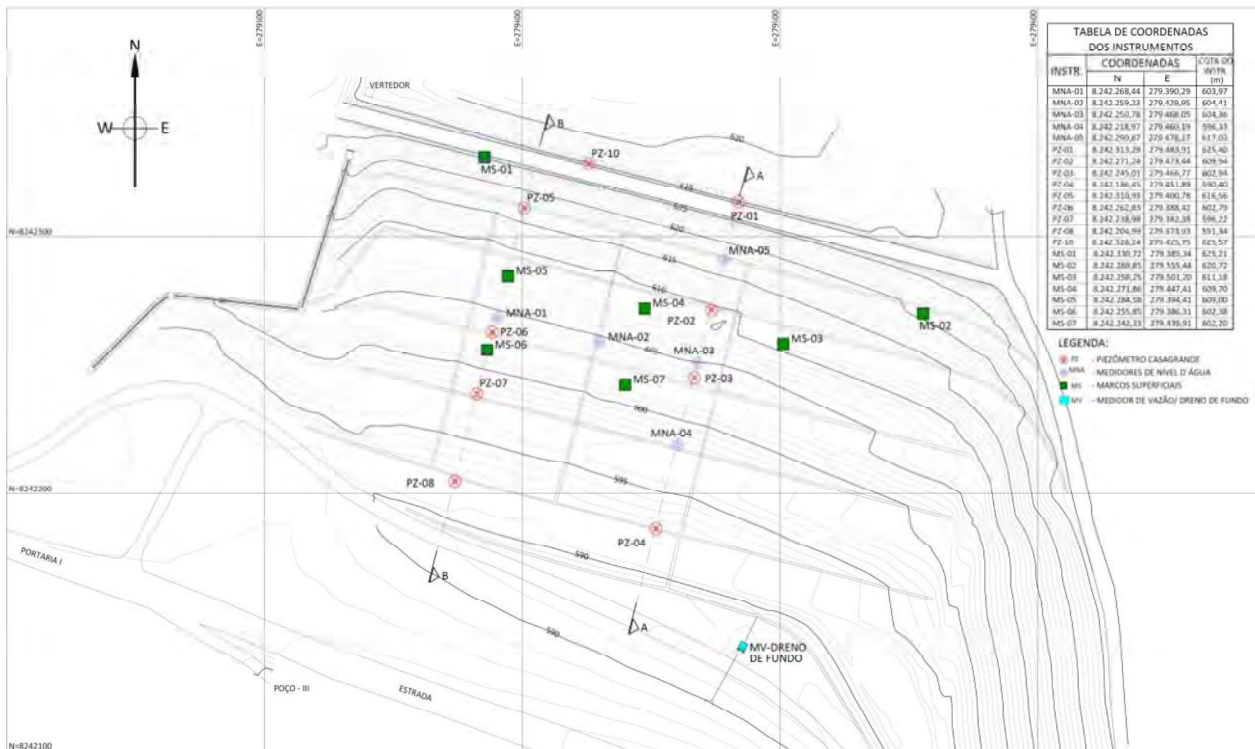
Planta de localização do monitoramento – Barragem Marçu.
